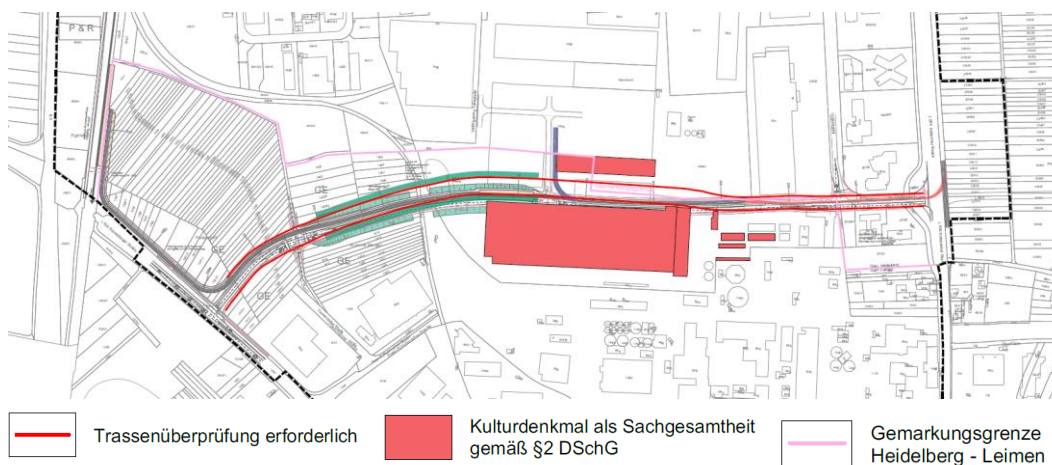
Überlagerung Denkmalschutz mit geplanter Trasse
